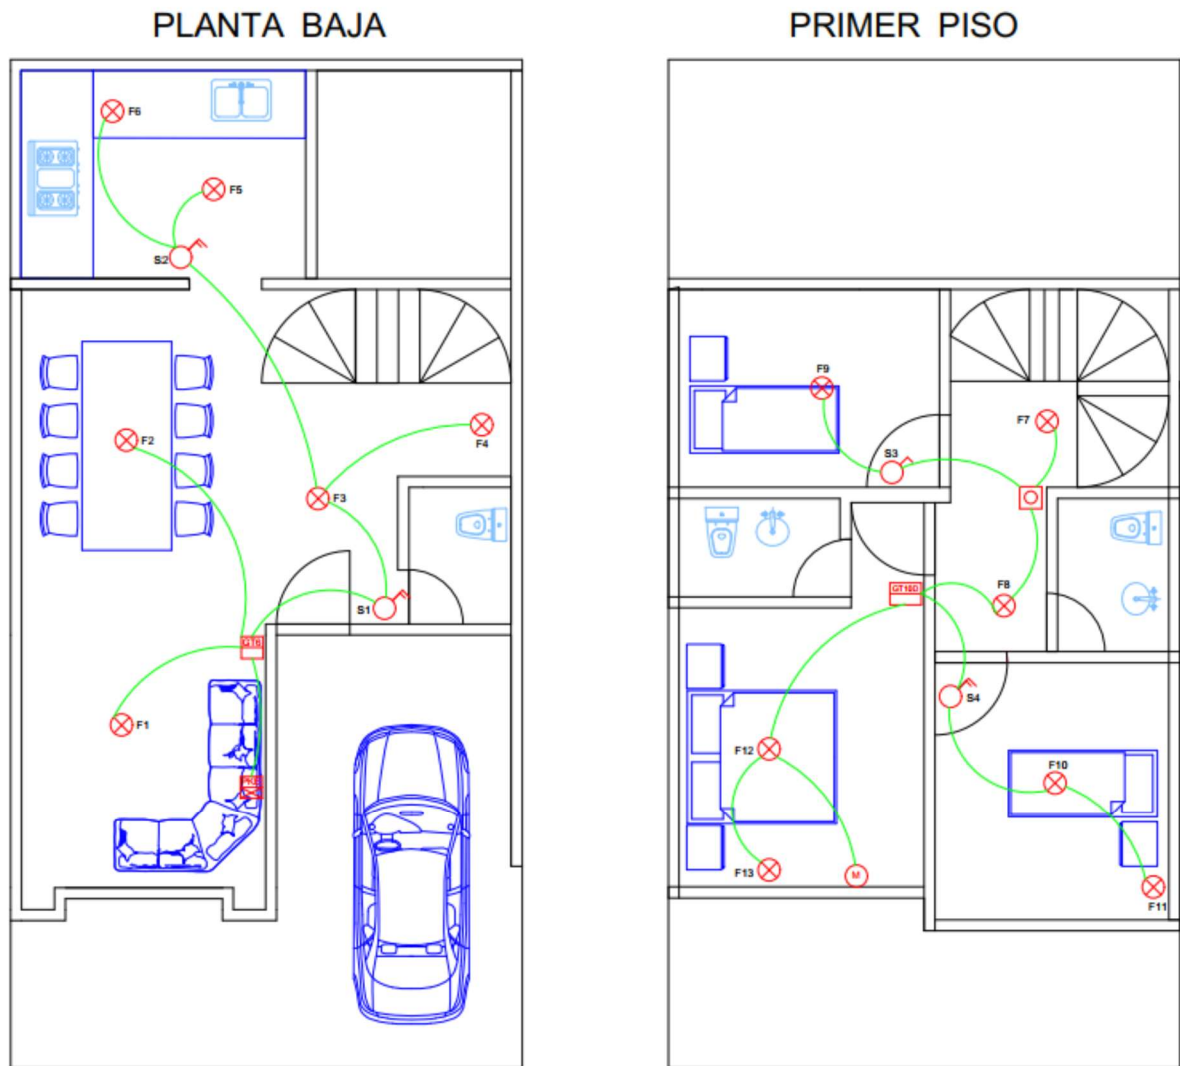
Planos de la vivienda con sistema domótico LCN
